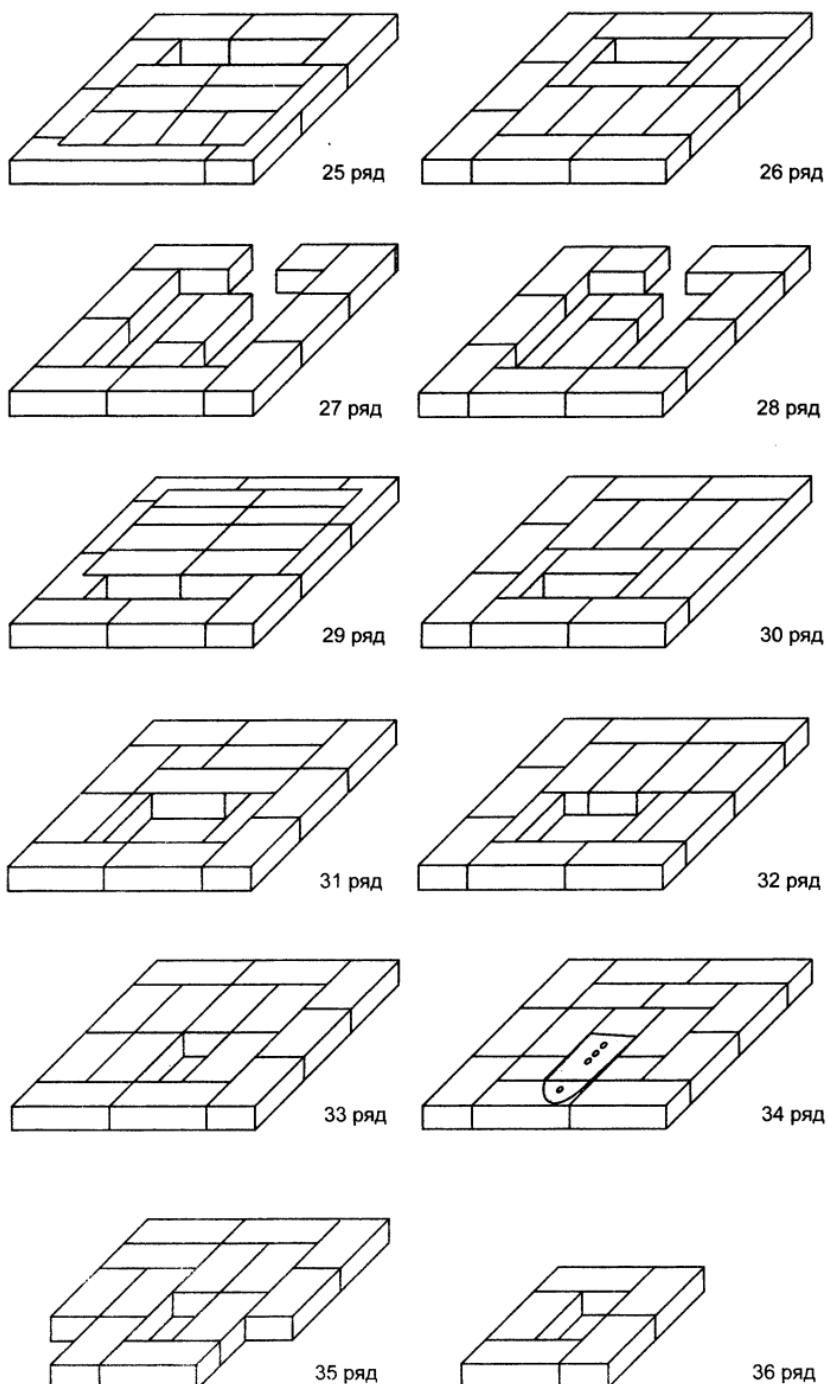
Кладка отопительной печи № 2 (продолжение)
